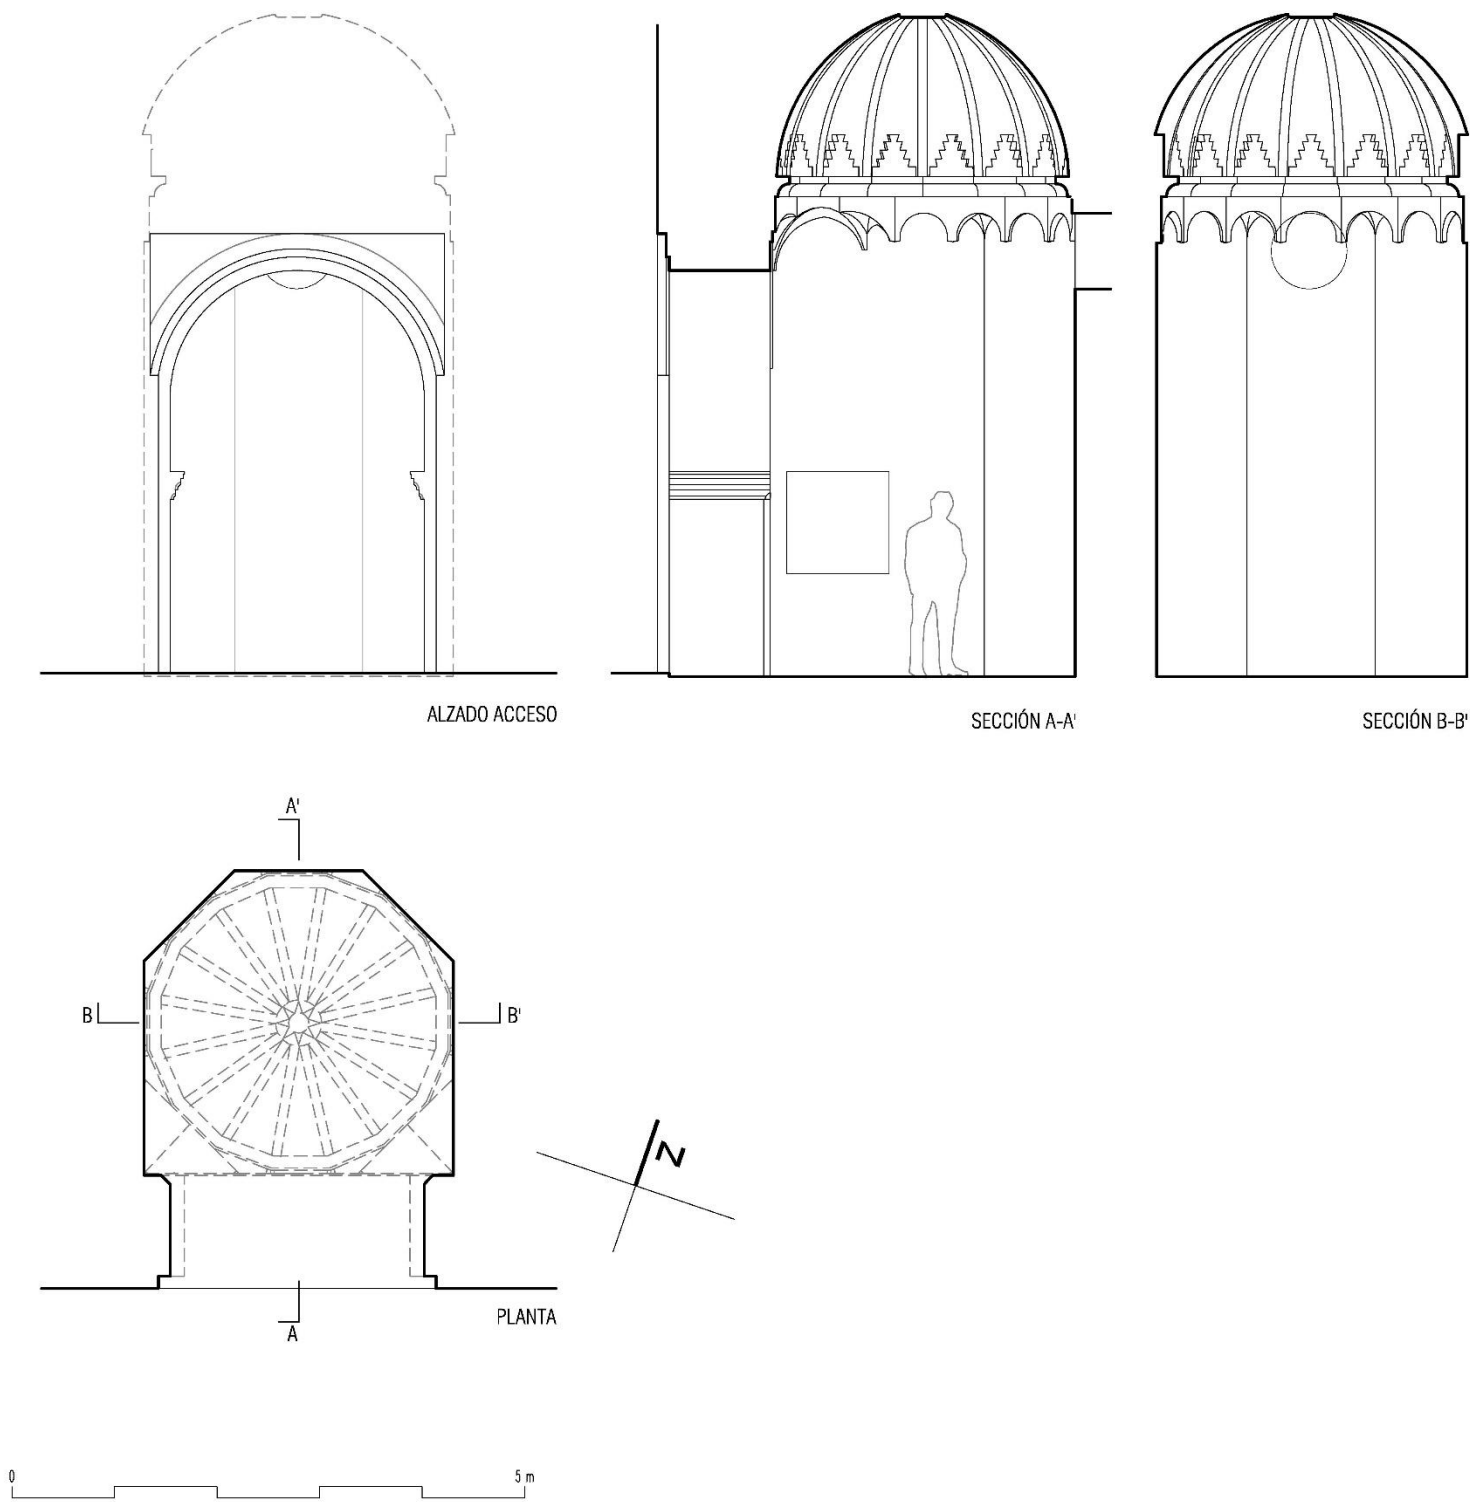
Planta y secciones. Capilla bautismal. San Marcos. Jerez.
